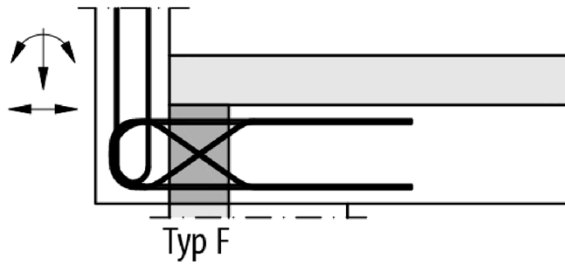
Schöck Isokorb® Typ F für vorgesetzte Brüstungen
